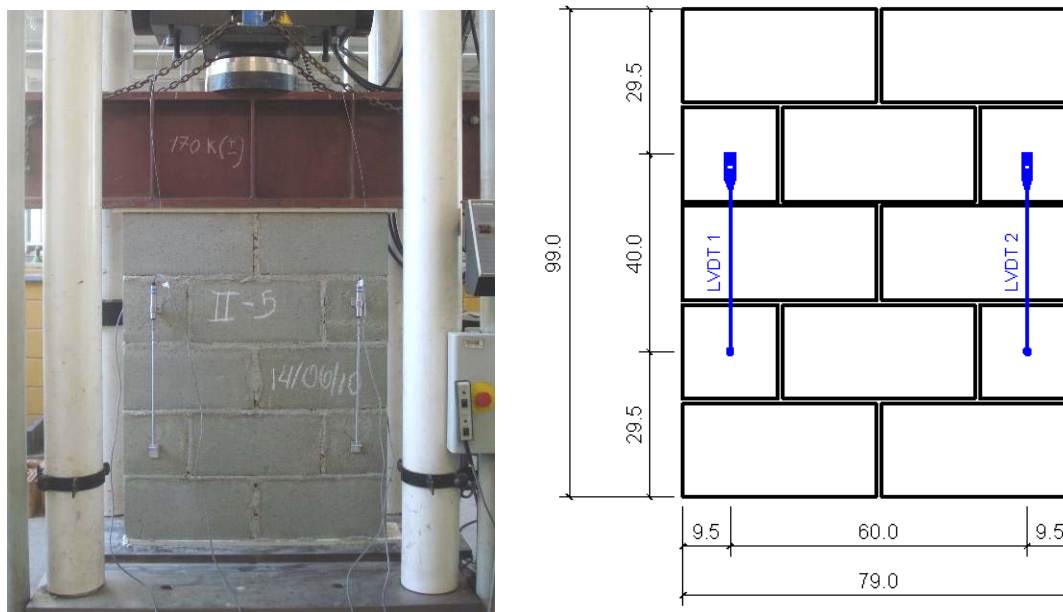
Ensaio à compressão das mini-paredes sem rapaduras (medidas em cm)
